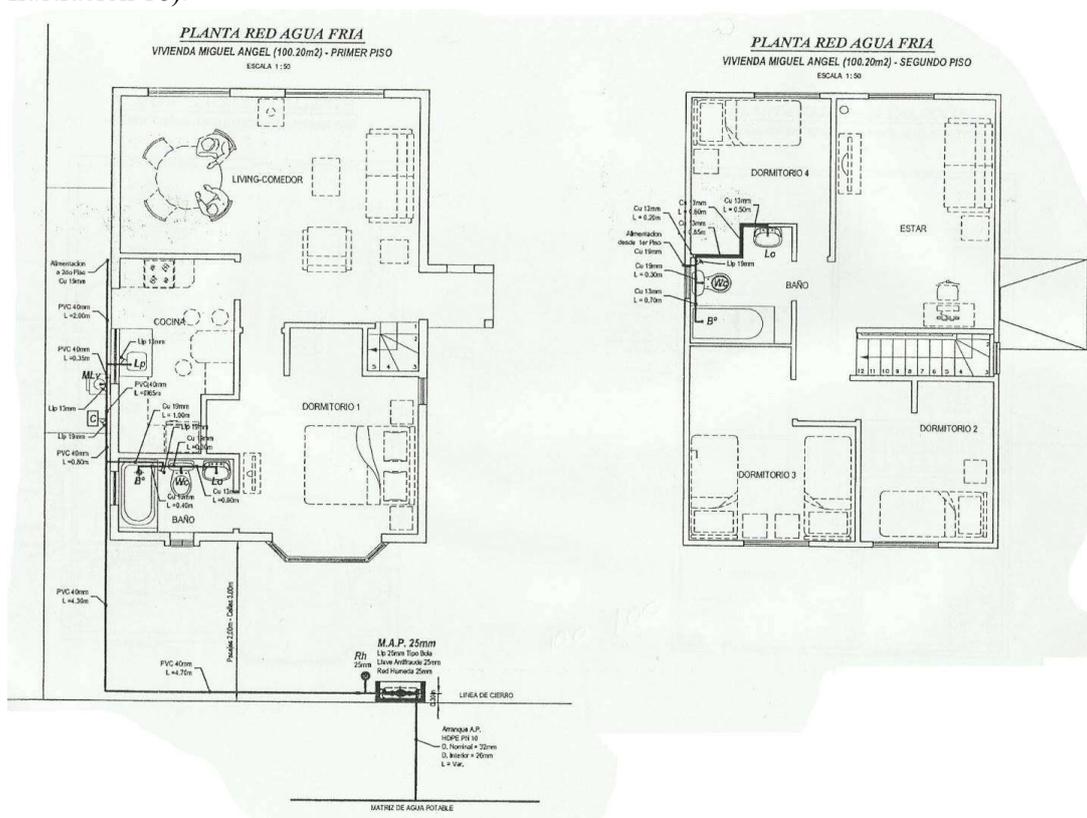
plano de planta red agua potable fría-caliente viviendas Miguel Ángel.
